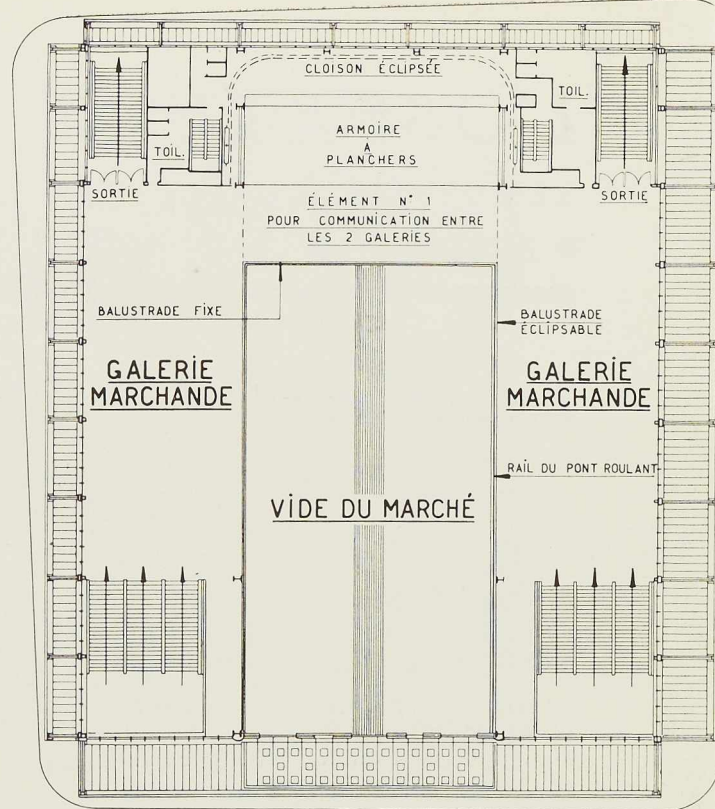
Plan des galeries du marché. Elles sont reliées par une passerelle constituée par l'élément n° 1 du plancher mobile.
